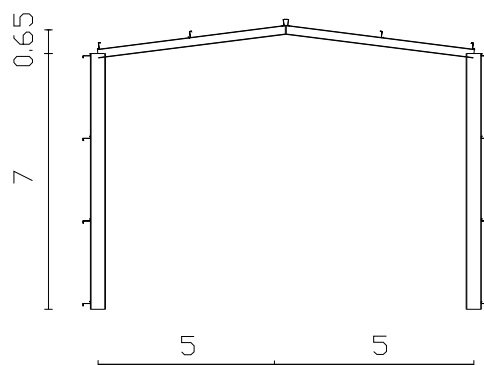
Pórtico rígido viga e pilar de alma cheia, vão de 10.00m
